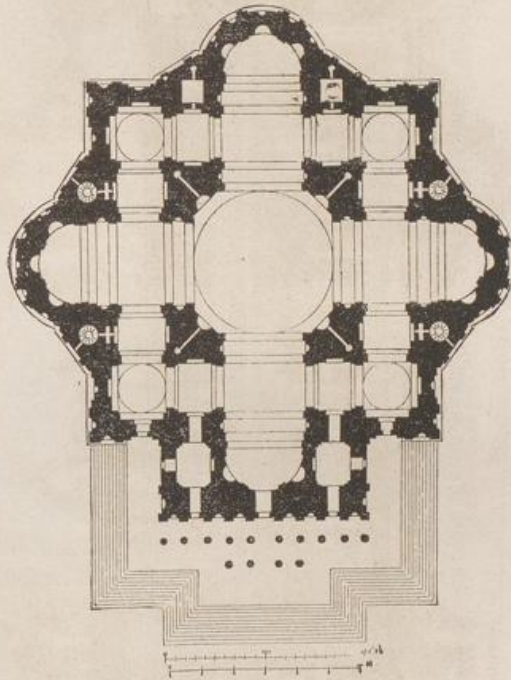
Michelangelo's Grundriss für St. Peter.
